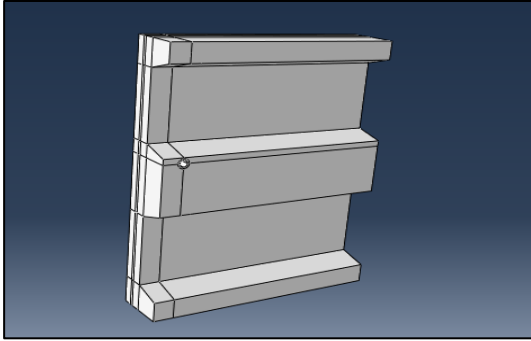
Vista en isométrico de la geometría de la losa con lamina de Steel Deck probeta Robinson (1988) (elaboración propia)
